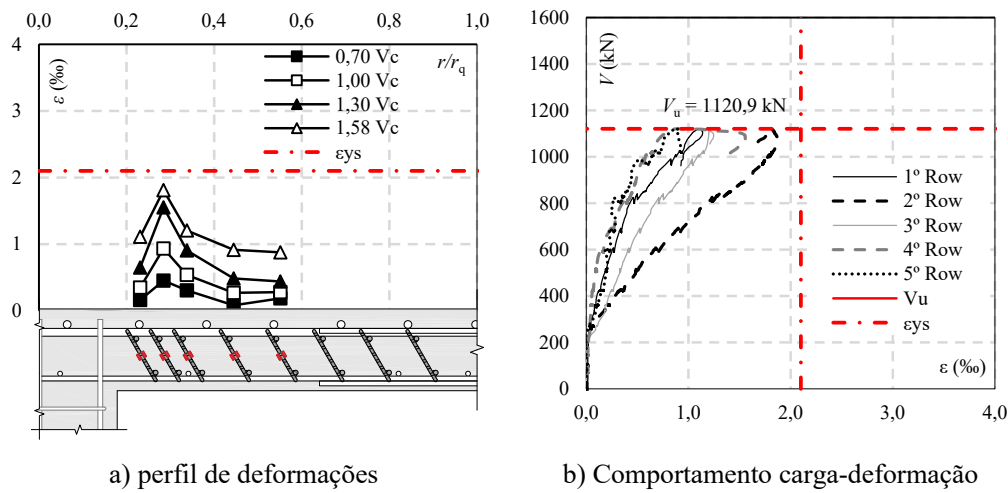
Deformações nas camadas de armadura de cisalhamento da laje SW5.
